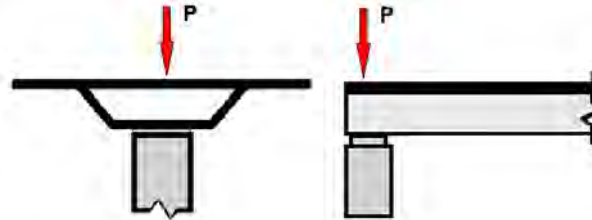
Sistema de carga en un puente simplemente apoyado
